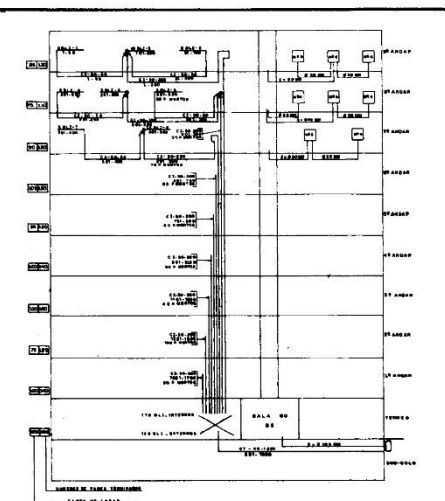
Projeto de cabeleagem com poço de elevação
